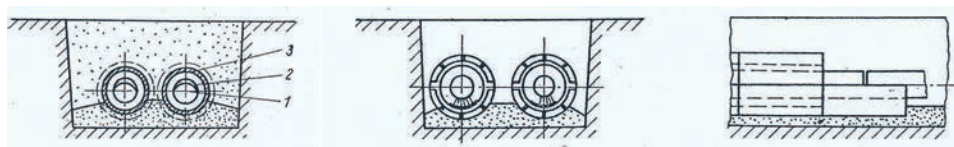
Stahlbeton Halbschalen 1 (verschiedene Autoren)
